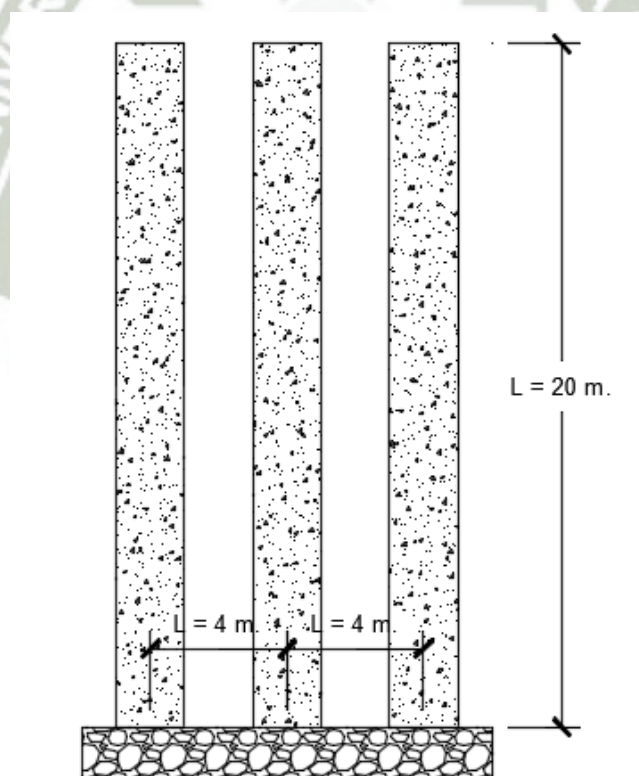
Vista en corte de los pilares laterales (Pilares 1 y 3) (Fuente: elaboración propia)
